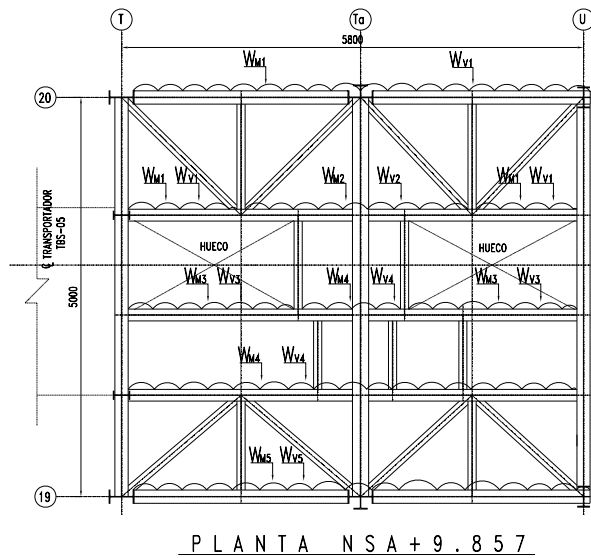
Plantas de Operación TT-6, con cargas distribuidas y estructuración
